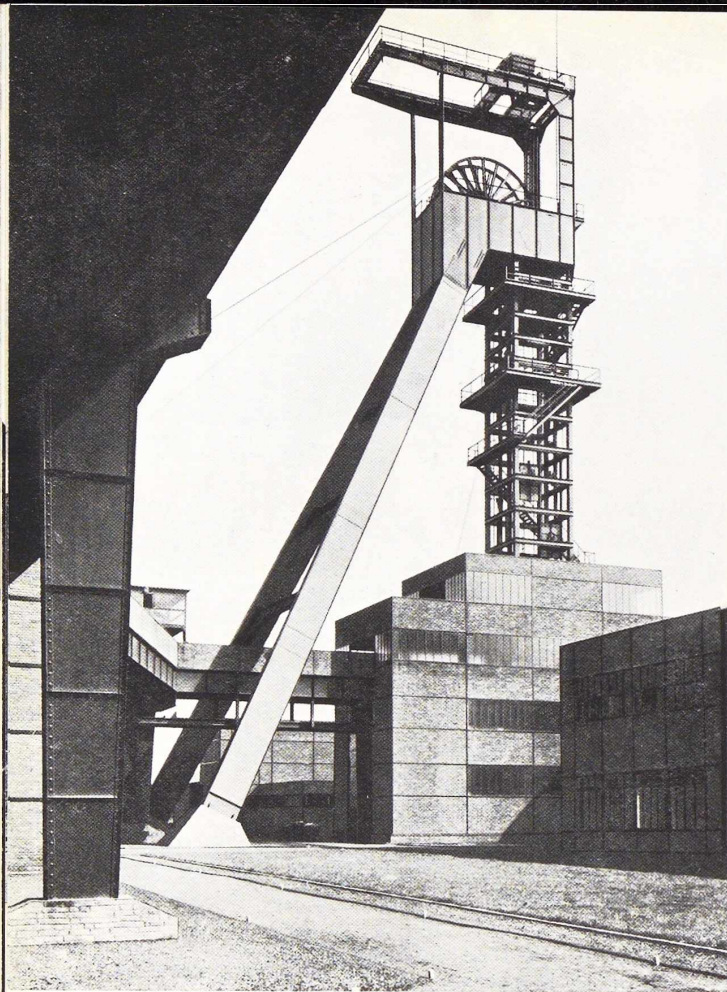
Le chevalement métallique construit en poutres à âme pleine du siège d'extraction « Friedrich Thyssen 2/5 ».
